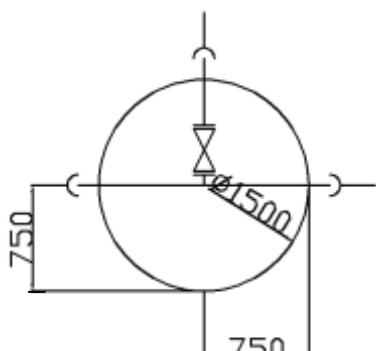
Схема присоединения ввода к наружной водопроводной
